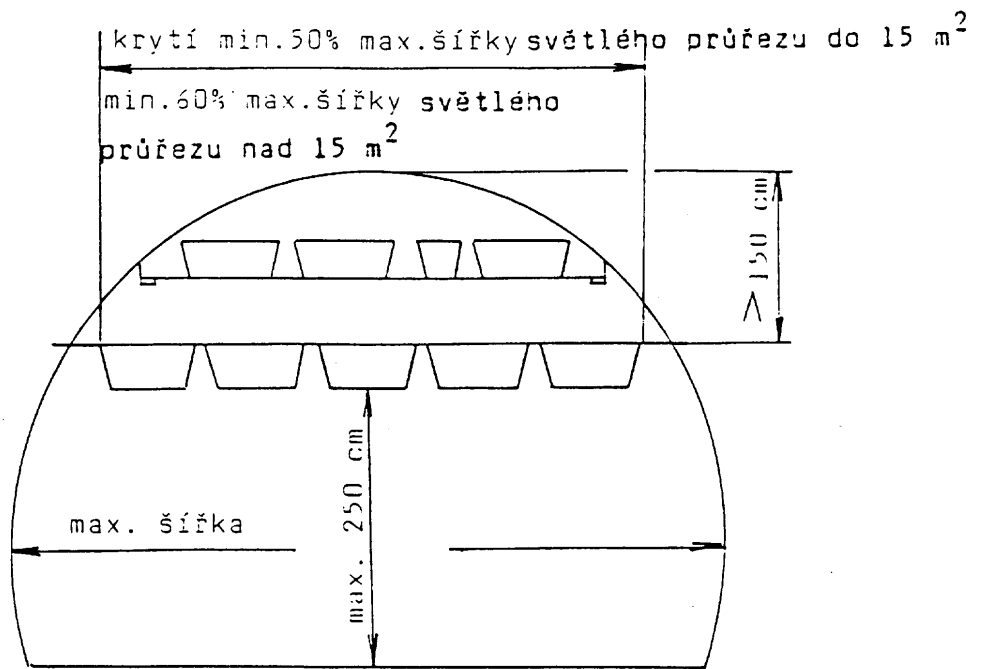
Přehrada prachové uzávěře – příklad umístění v důlním díle
